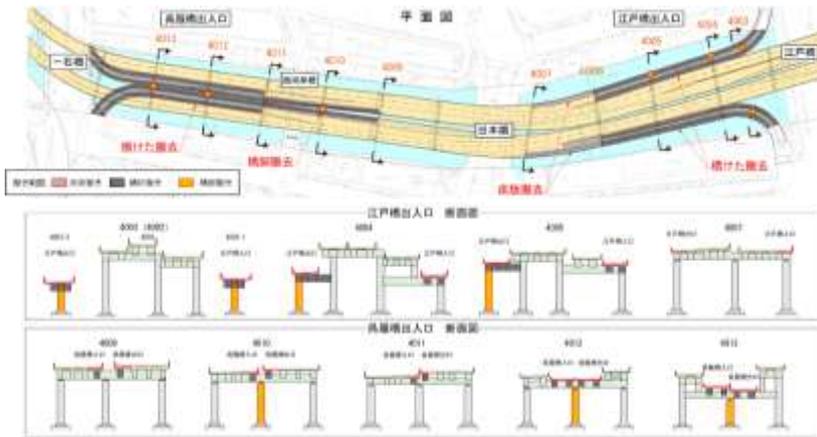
江戸橋・呉服橋出入口撤去工事 平面図、断面図
